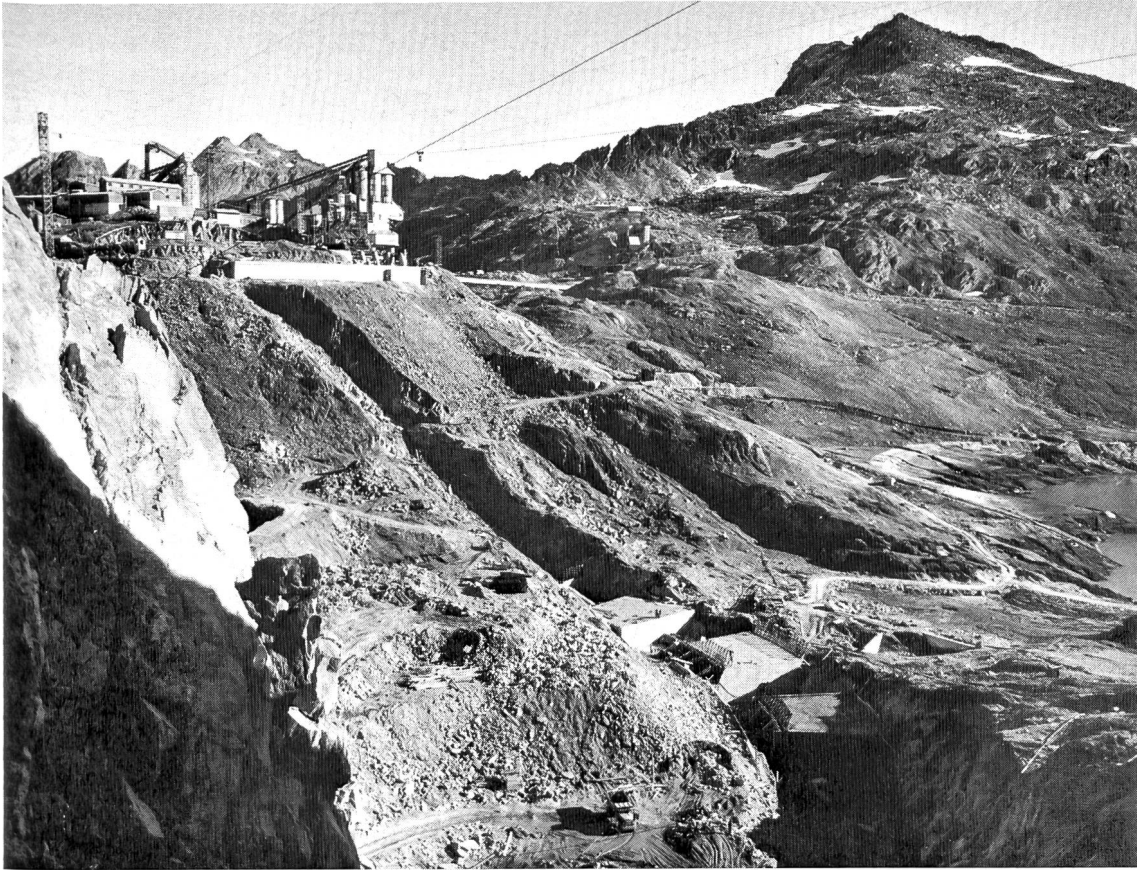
Baustelleneinrichtungen, Baugrube und erste Betonblöcke der Staumauer Naret I. Rechts abgesenkter natürlicher Naretsee. Im Hintergrund Steinbruch für Kiessandgewinnung (Oktober 1967).
